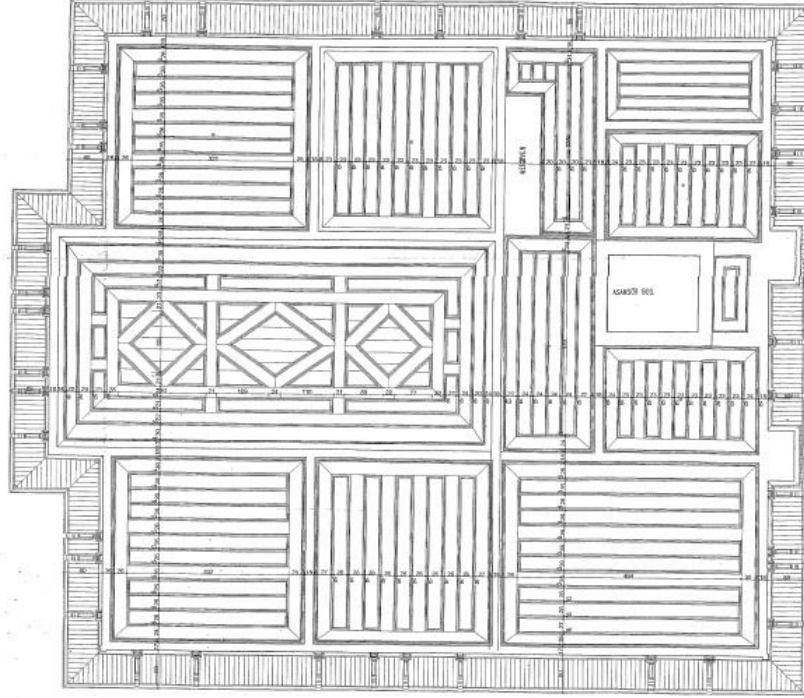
Gençlik Sanat Merkezi, 2. Kat Planı
